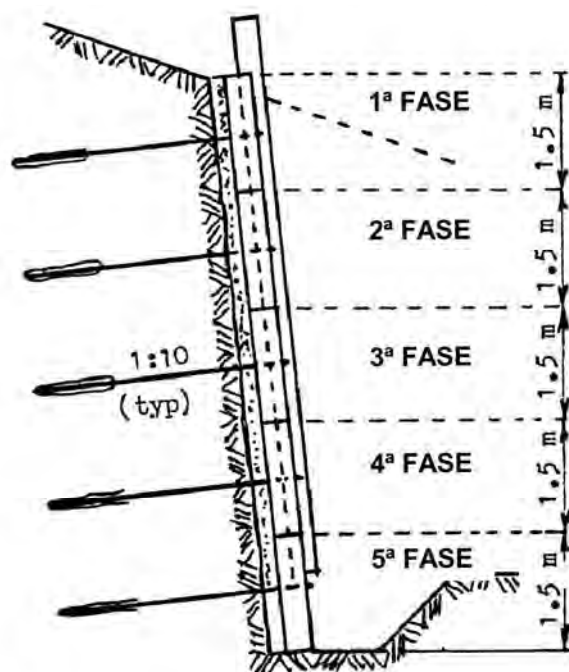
MURO ANCLADO CONSTRUIDO POR FASES (Wingreis, Suiza)
